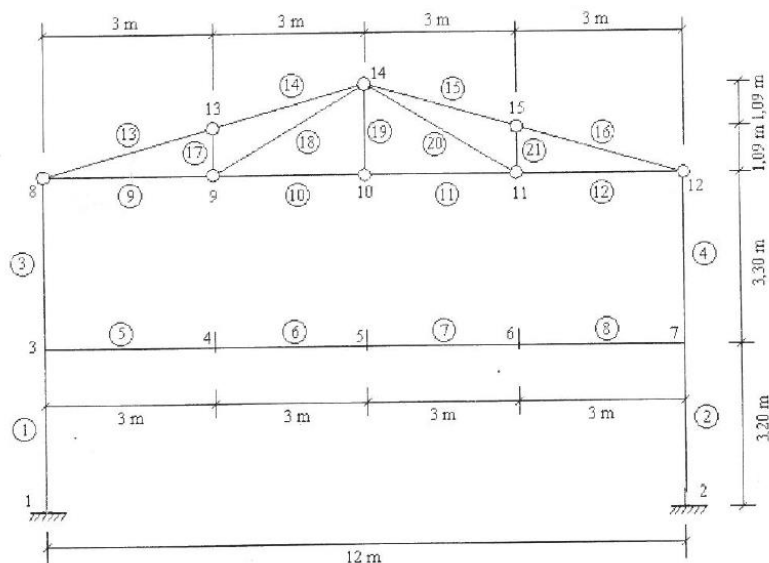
Distribuição dos nós, vigas, numeração de barras e pilares
